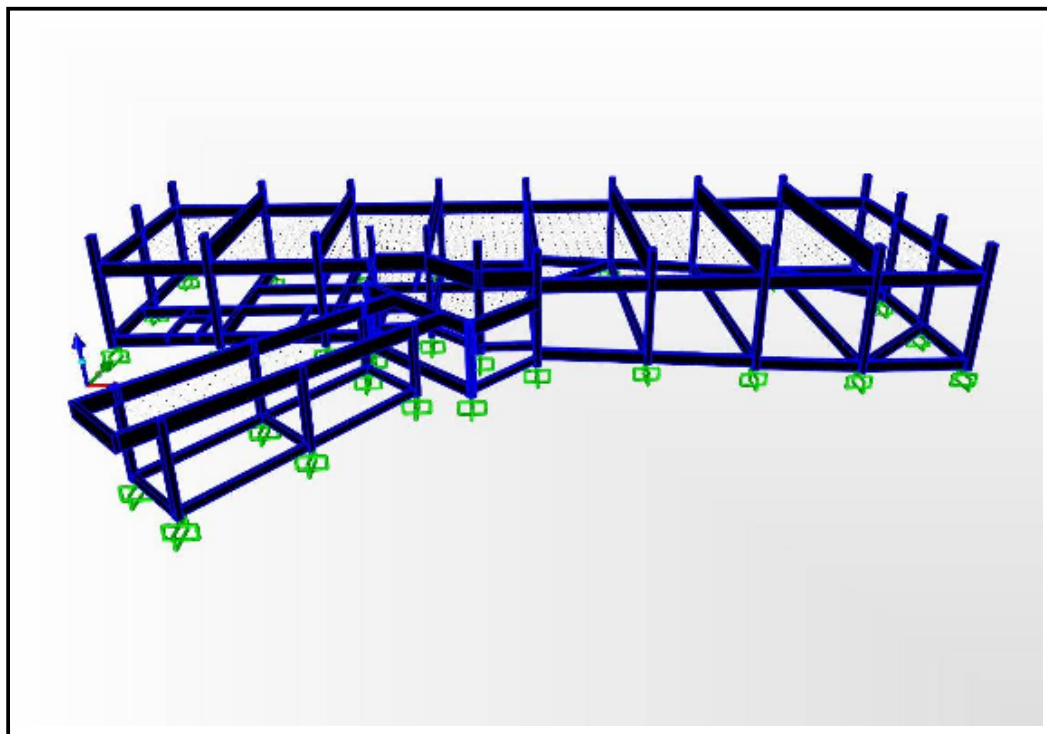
Vista em perspectiva norte do modelo estrutural apresentando somente os elementos de barra
